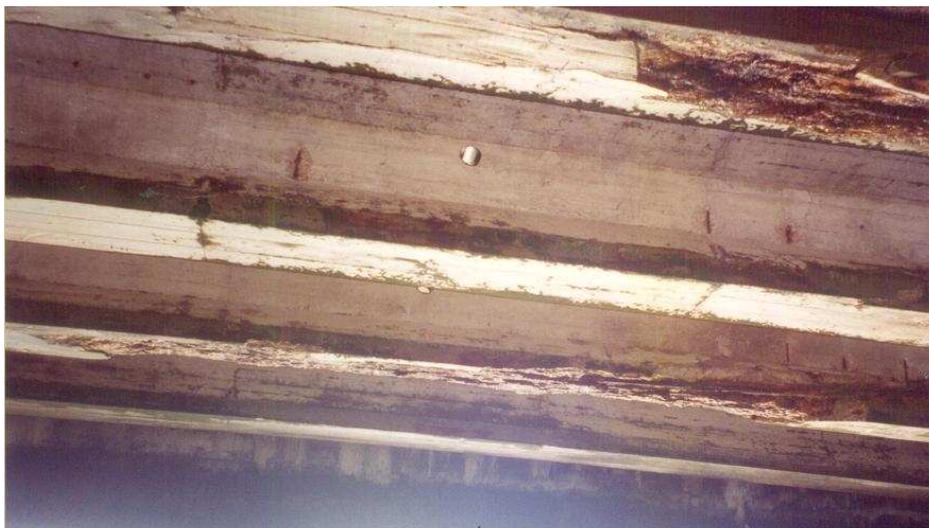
Cais N.º 5. Corrosão nas estacas prancha e desgaste da superestrutura
